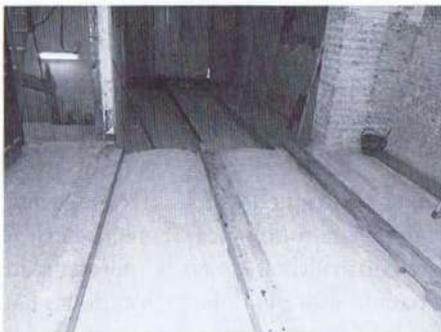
Forjado de vigas y revoltones con el refuerzo de las vigas realizado con costillas de madera.
